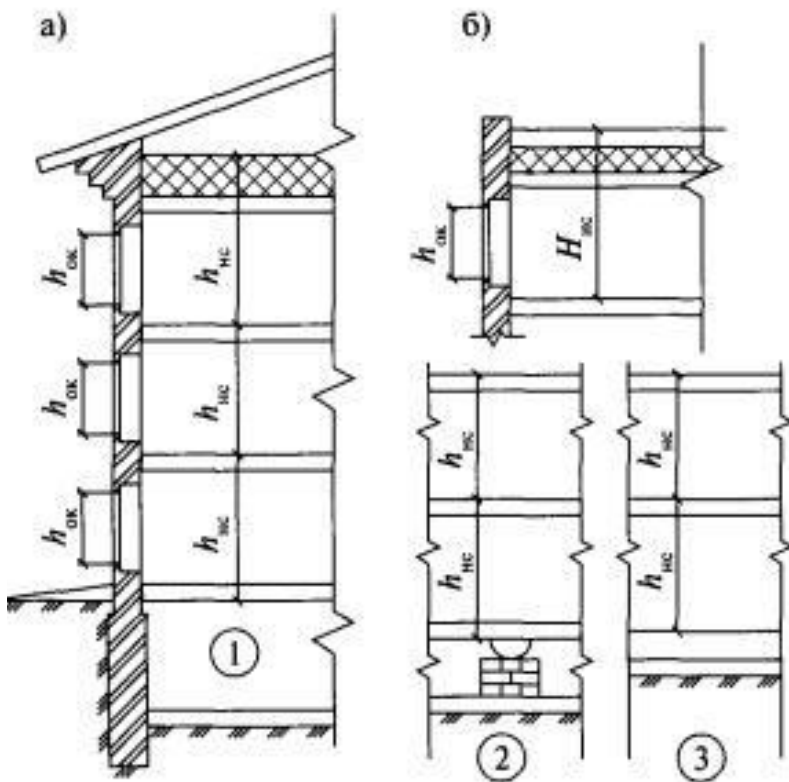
Правила обмера площадей ограждающих конструкций: а – разрез здания с чердачным перекрытием; б – разрез здания с совмещенным перекрытием; 1 – пол над неотапливаемым подвалом; 2 – пол на лагах; 3 – пол на грунте
